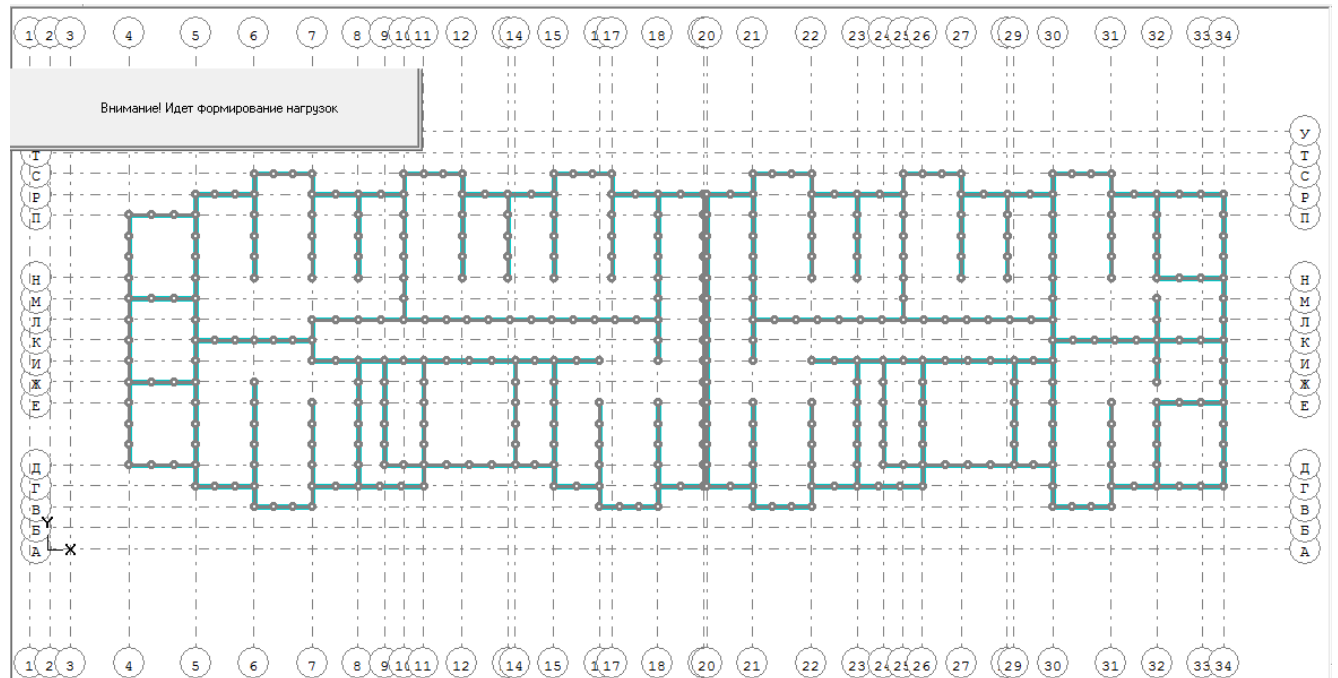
Схема розрахунку плити перекриття типового поверху.
